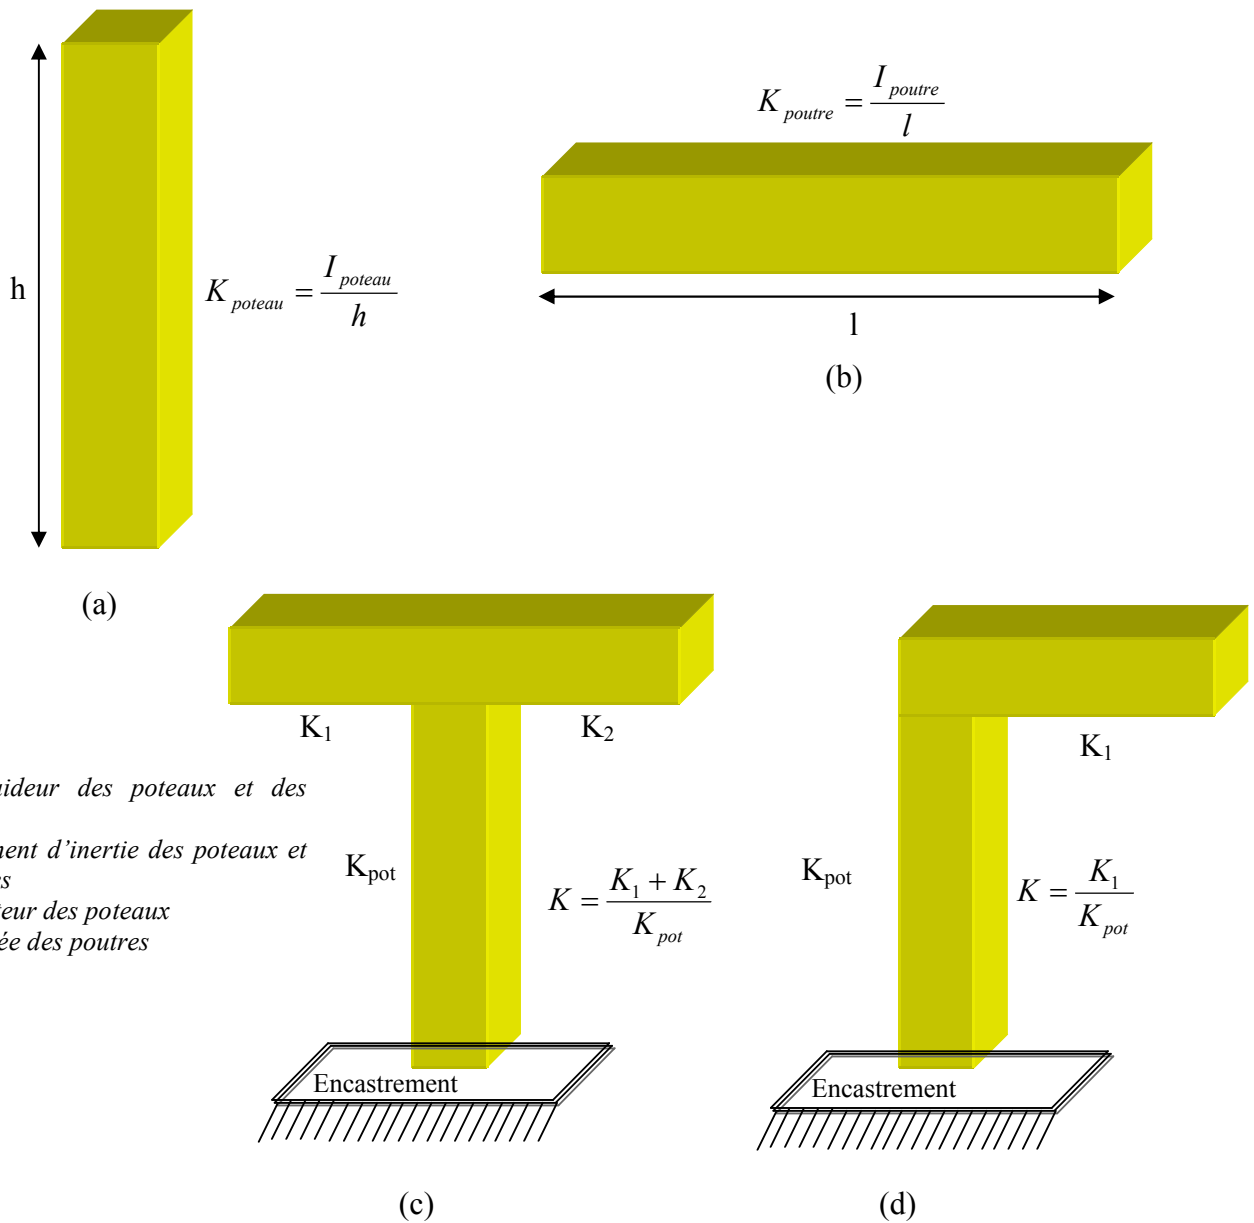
Présentation de la méthode MUTO pour un niveau RDC ; (a) : raideur d'un poteau, (b) : raideur d'une poutre, (c) : raideur d'un assemblage en travée, (d) : raideur d'un assemblage en coin
